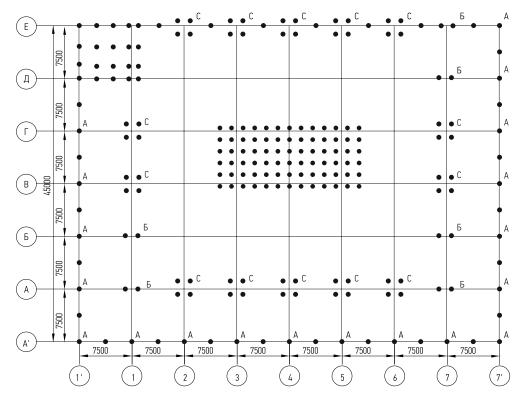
Схема расположения свай для варианта каркаса с применением стальных конструкций при сетке 7,5х15 м
